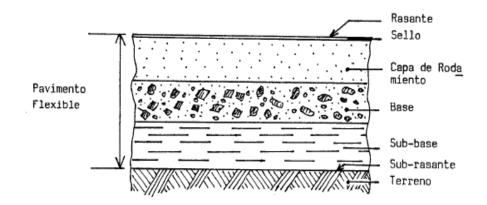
Fotografía de un Pavimento Flexible Fuente: Manual de procesos Constructivos para Pavimentos de baja intensidad del tráfico de el Salvador utilizando concreto hidráulico simple y emulsiones asfálticas.
